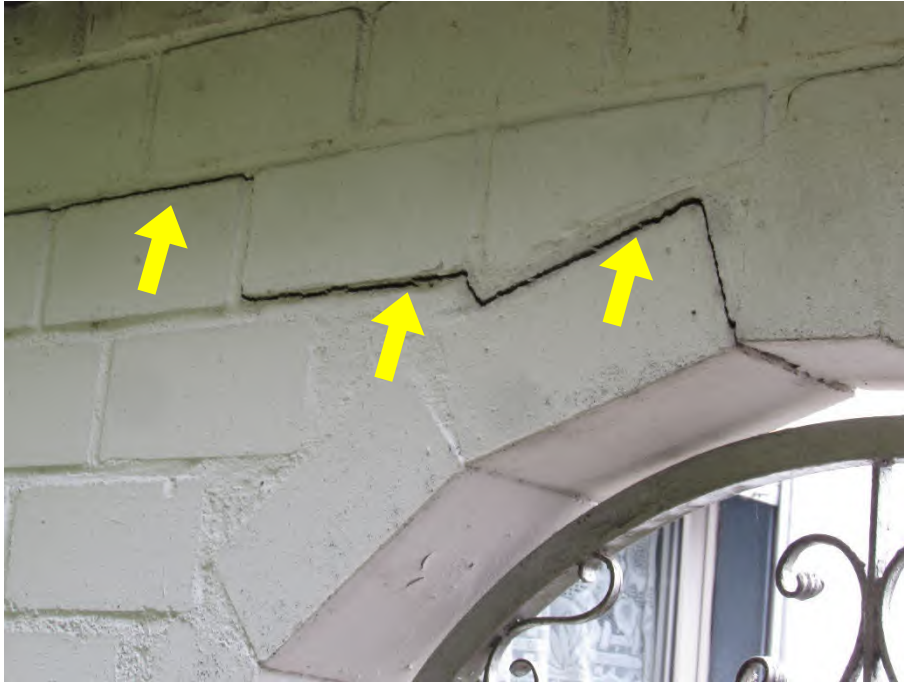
gerissenes Mauerwerk im Zugangsbereich
